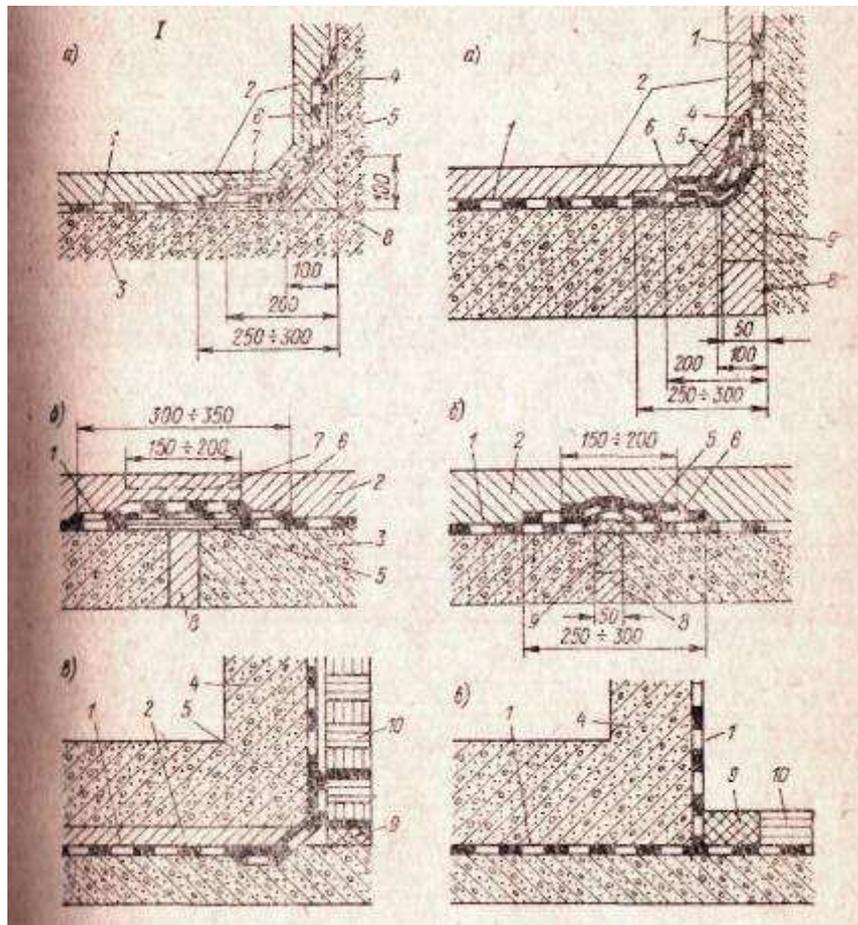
Способы усиления гидроизоляционного покрова (к п. 2.24)
